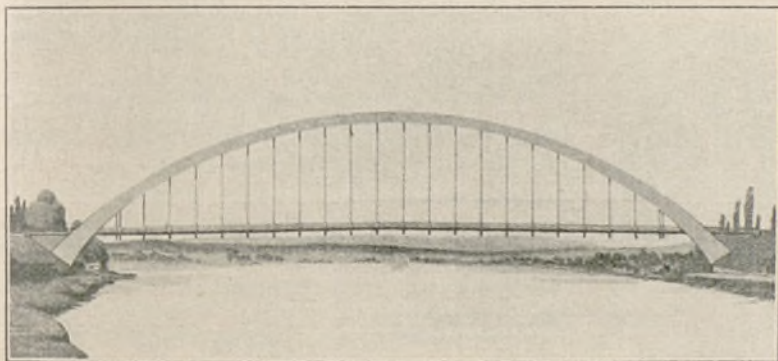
Puente de hormigón armado de 125 metros construído sobre el Sena.
